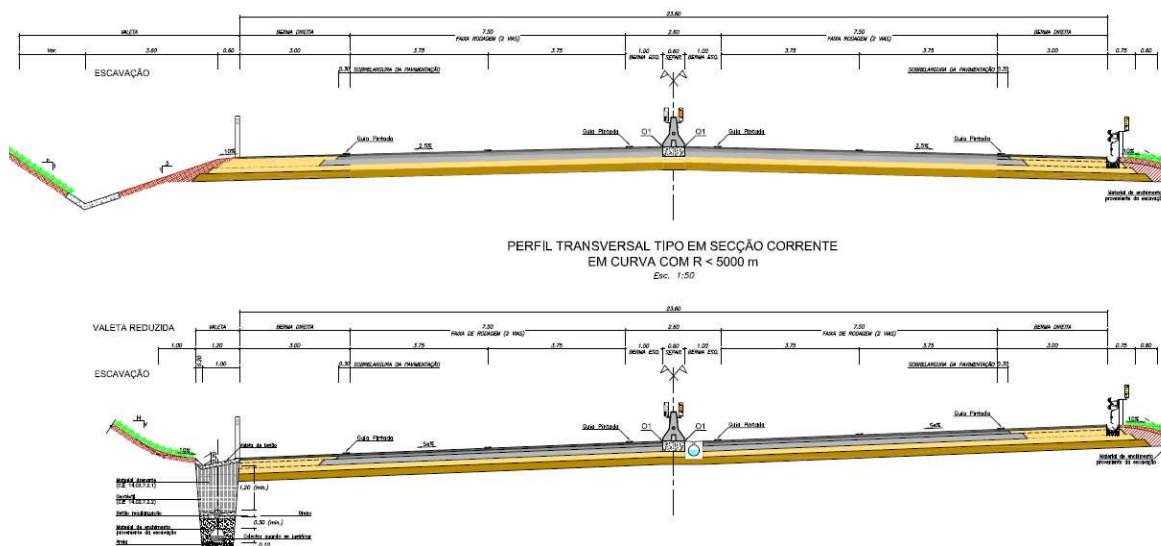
Perfis transversais tipo da secção corrente (Plena Via) da autoestrada a construir. Fonte: Projeto Execução da OE.
